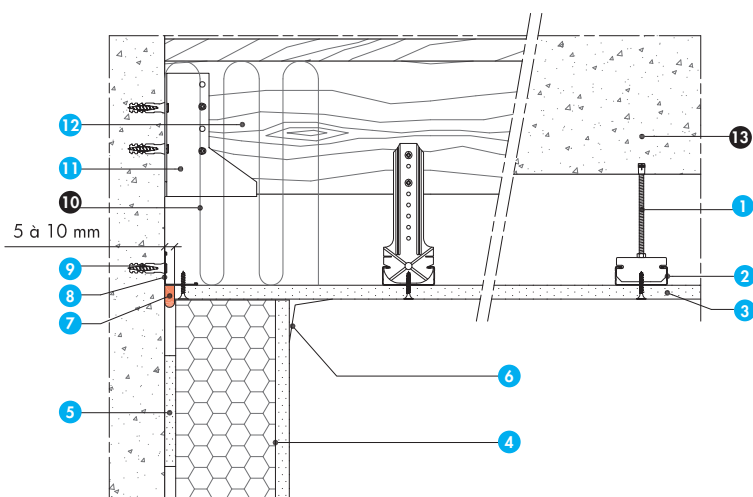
Étanchéité à l'air de la jonction plafonds/support/doublage
